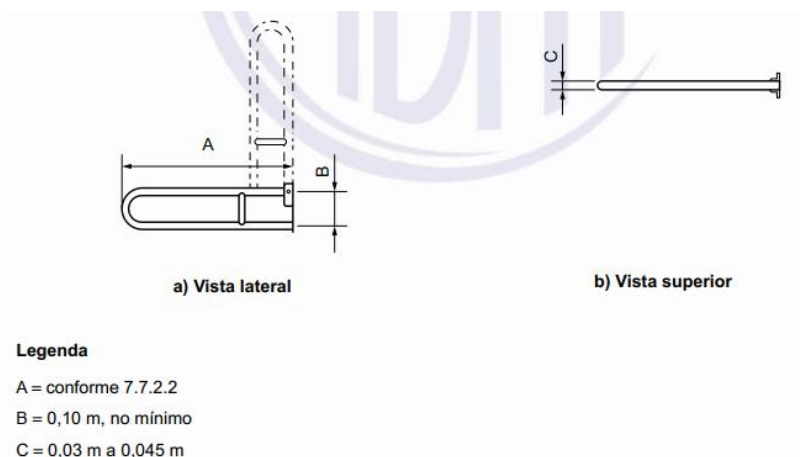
Barra de apoio lateral articulada para bacia sanitária
